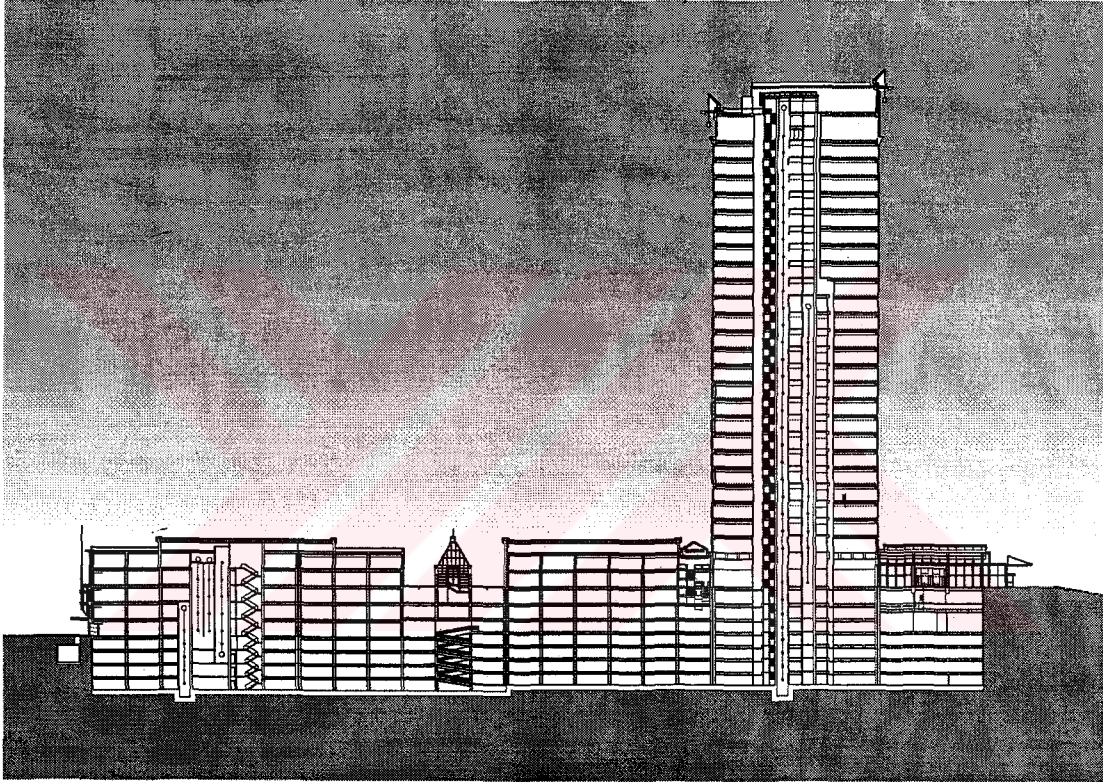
Tekfen Tower Binası Genel Görünüşü³²
